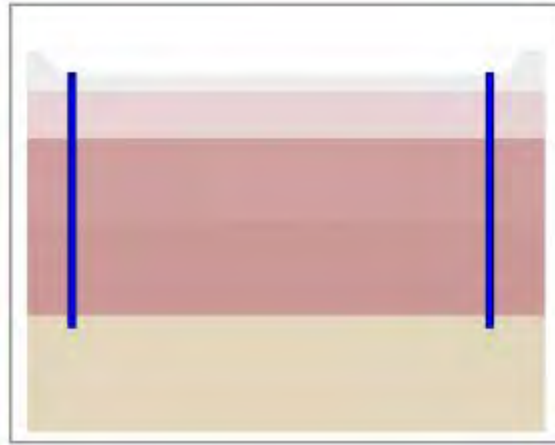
Construcción de estructuras perimetrales. Fuente: Pilotes Terratest Perú S.A.C, 2021
